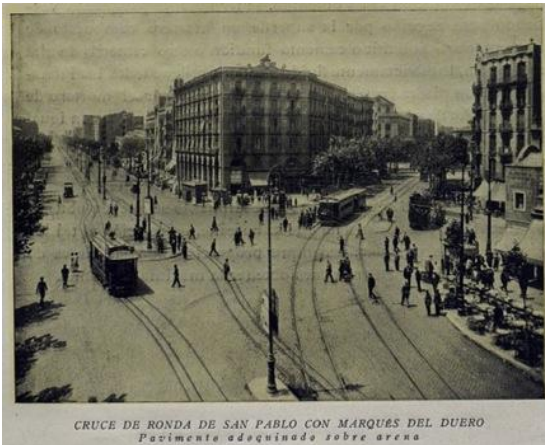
> Avenida Paral·lel con Ronda Sant Pau, pavimento adoquinado sobre arena (Ayuntamiento de Barcelona 1926, p.30)
